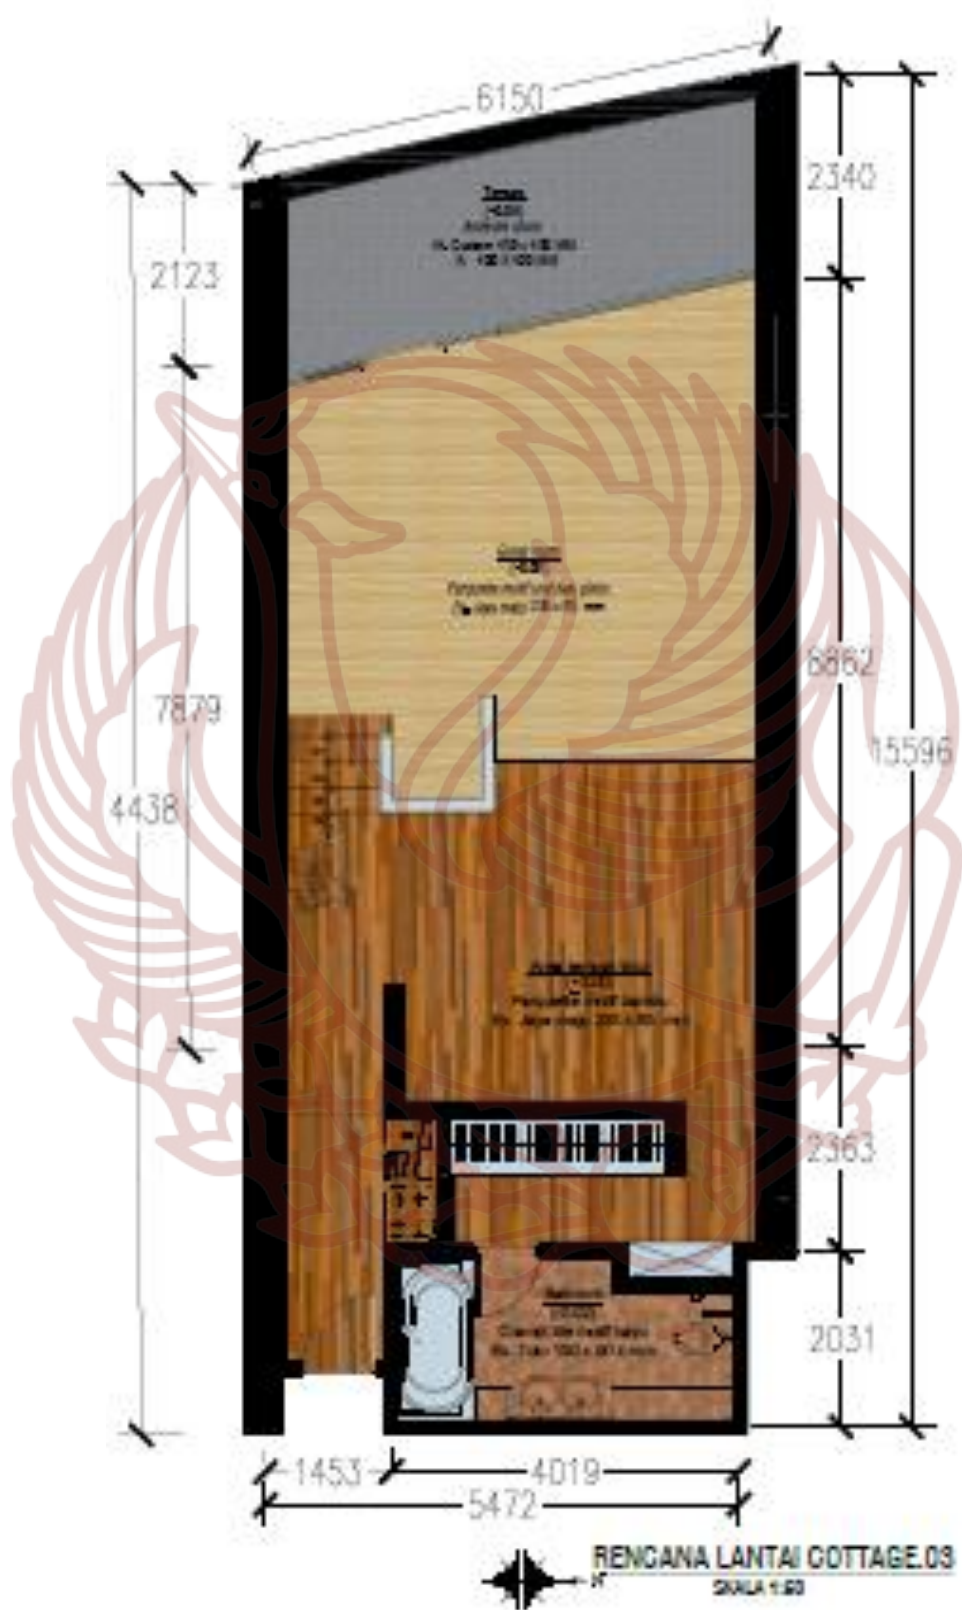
Rencana Lantai *Cottage* tipe 1
